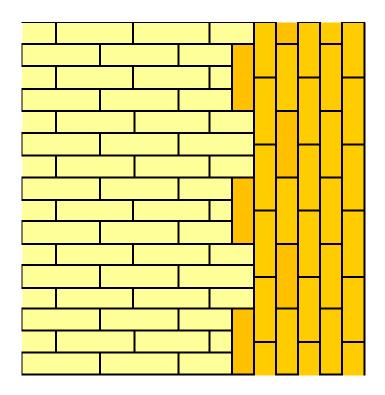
Juxtaposition des poses horizontale et verticale des panneaux isolants sur une même façade
